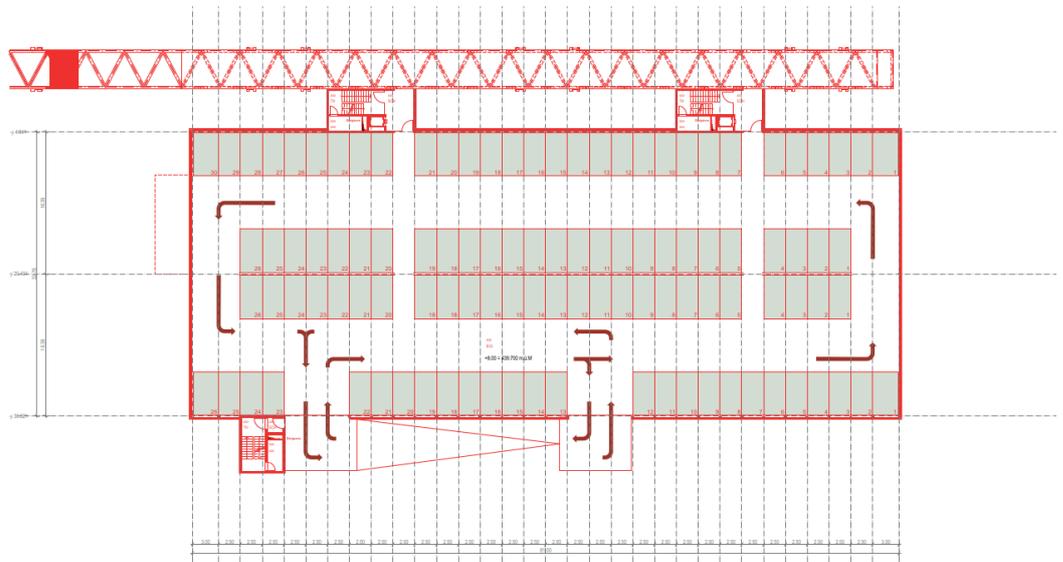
Grundriss Ebene Personenwagen (Richtprojekt, ANS Architekten)
